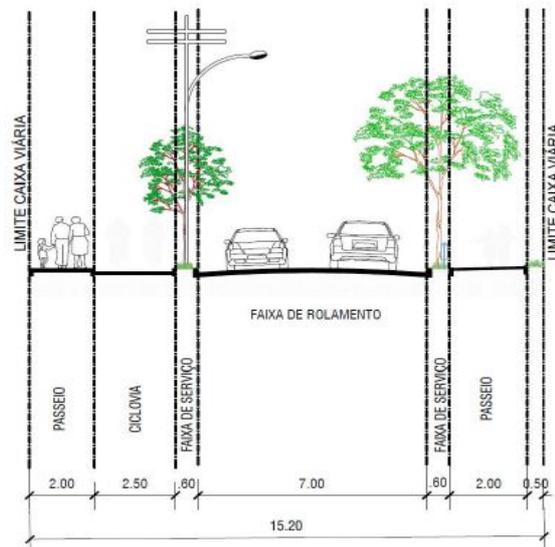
Via de Circulação de Vizinhança 1 – Rua das Figueiras e Rua Parque Tangar. Fonte: MDE EP
